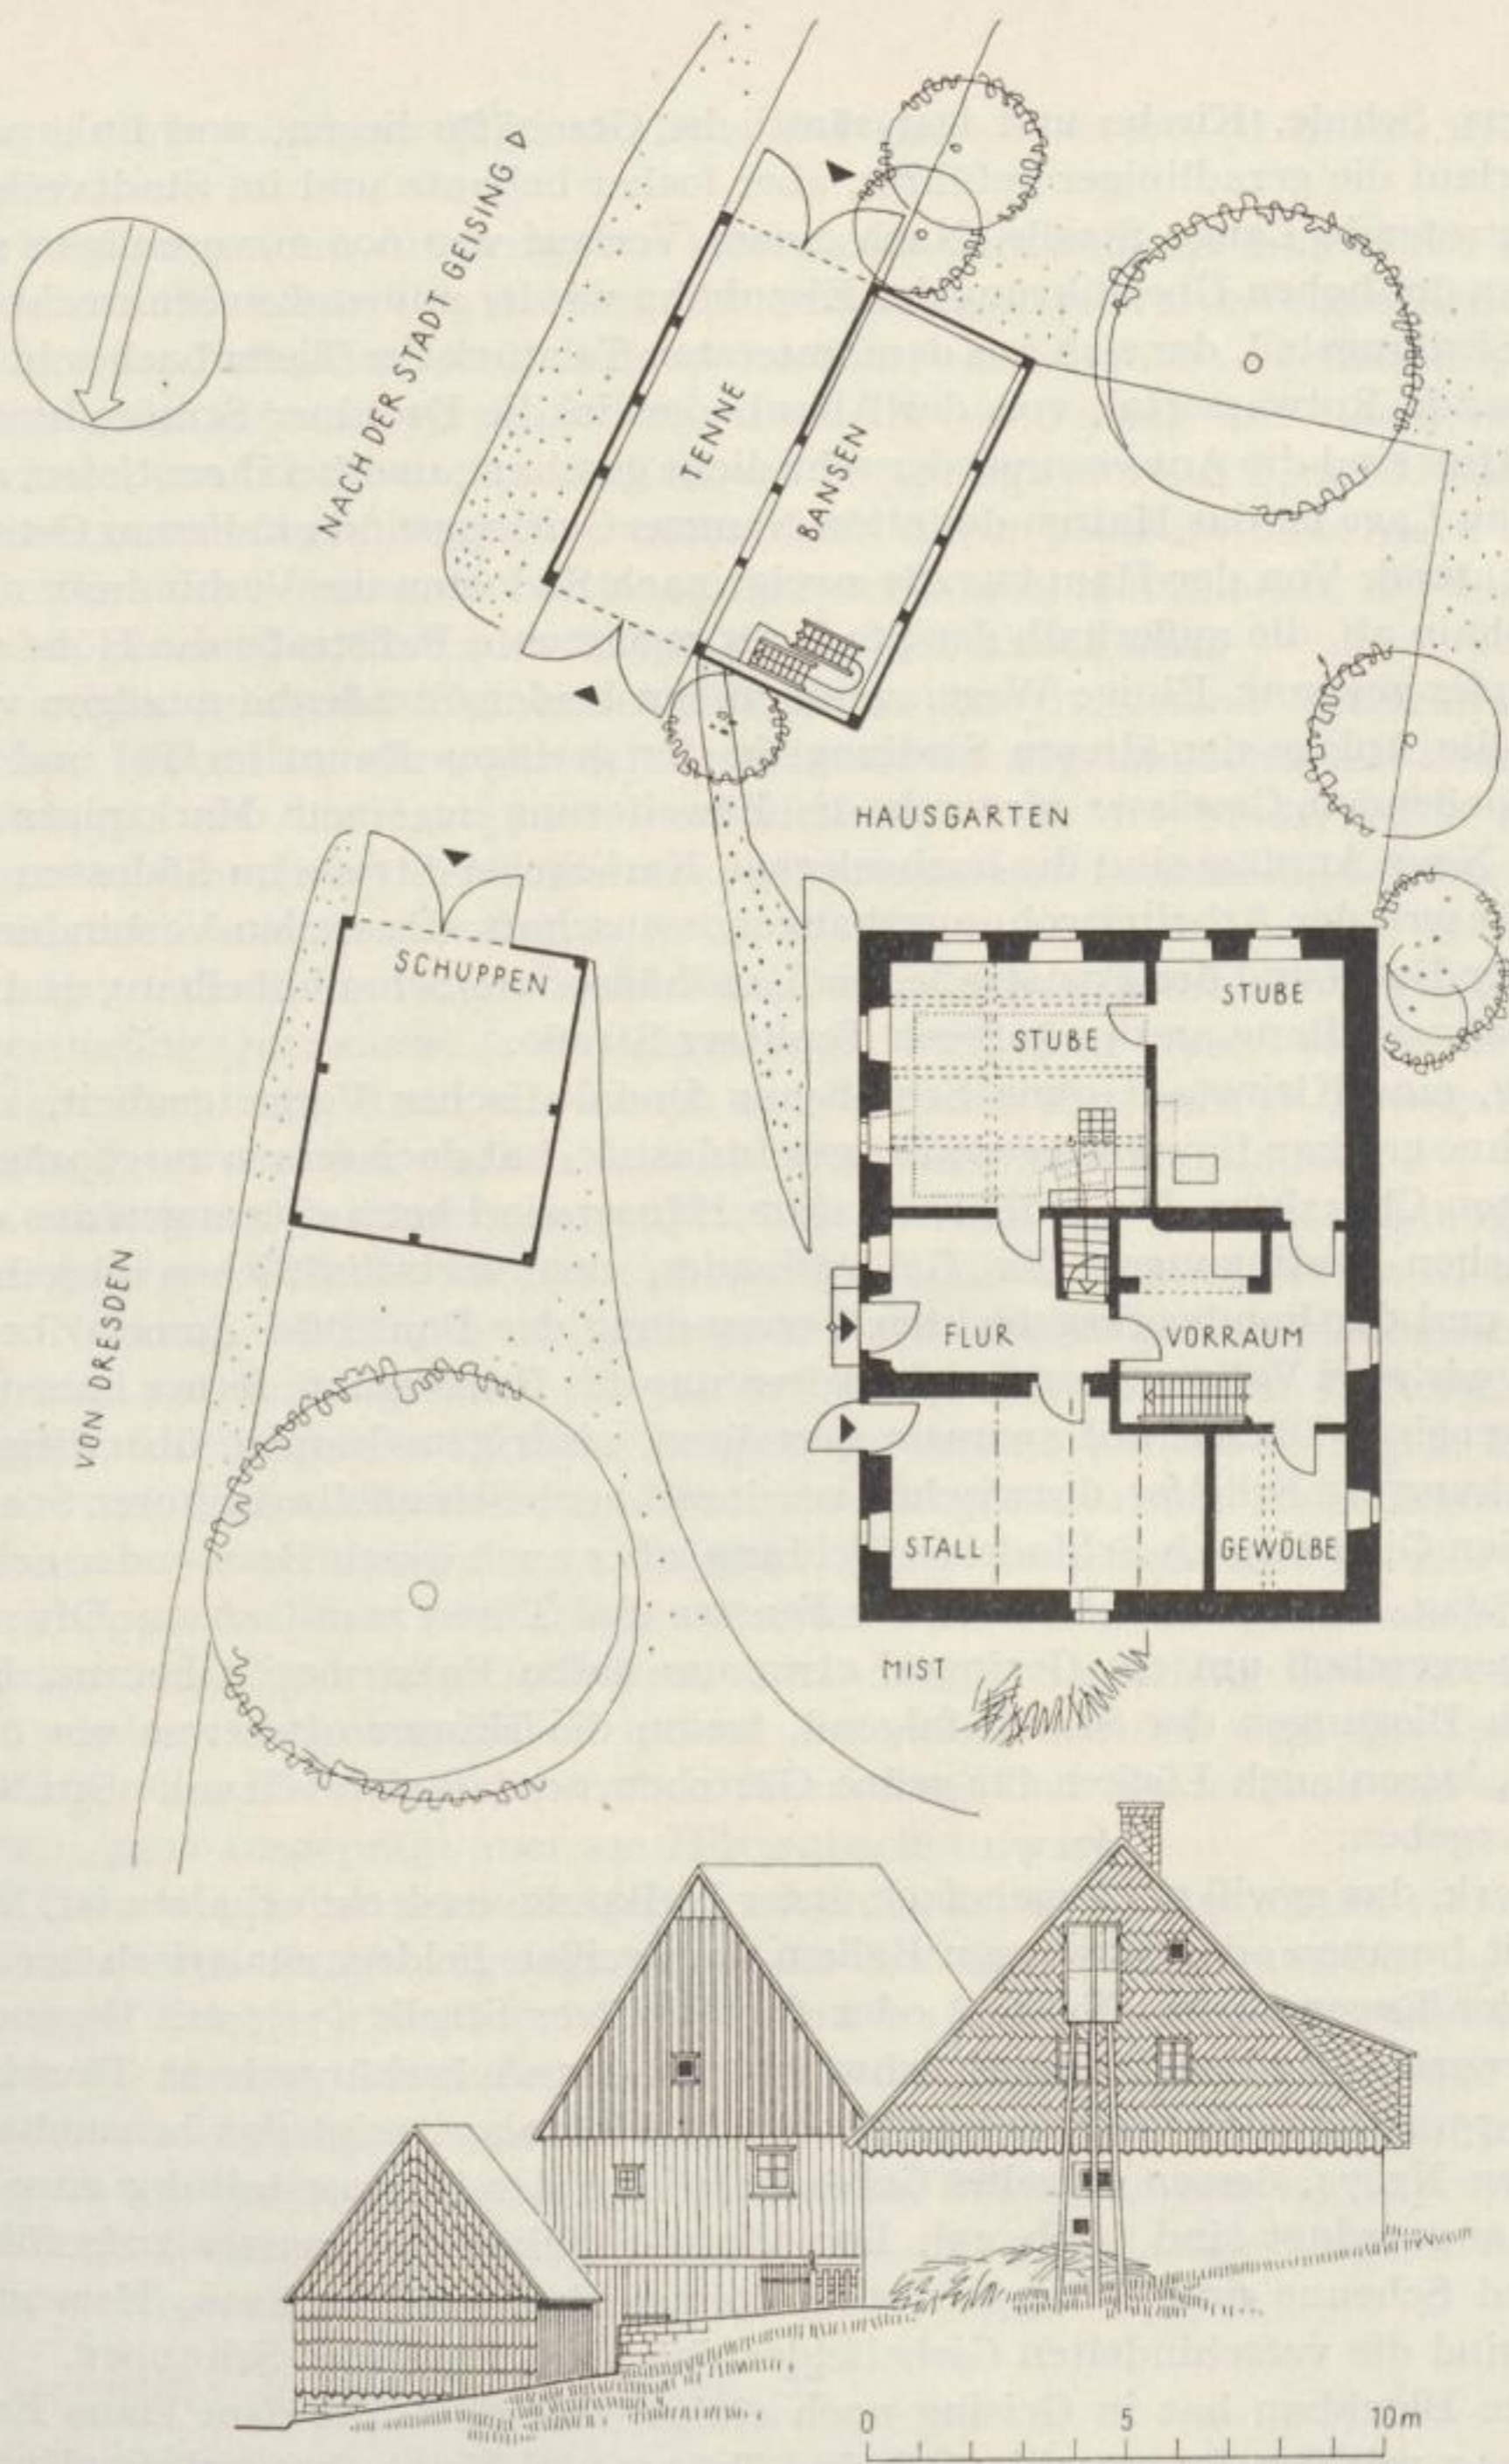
Bauernhof in Geising, Dresdner Straße 74. Lageplan mit Grundrissen und Ansicht
